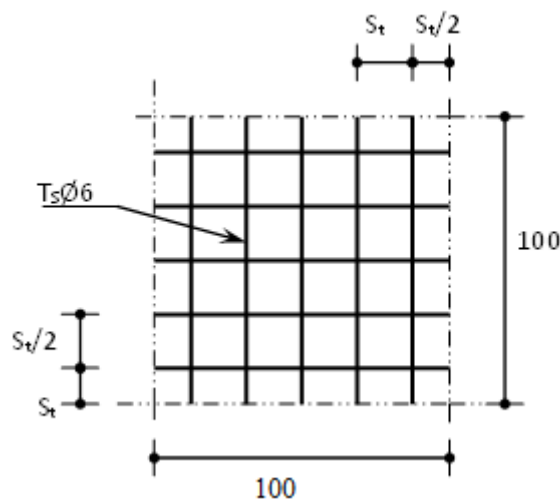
Disposition constructive des armatures de la dalle de compression
